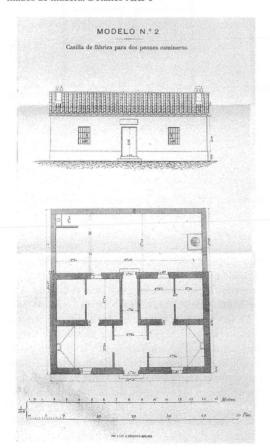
Modelo nº 2 Casilla para dos peones camineros con entramados de madera. Planta y alzado AHPT
